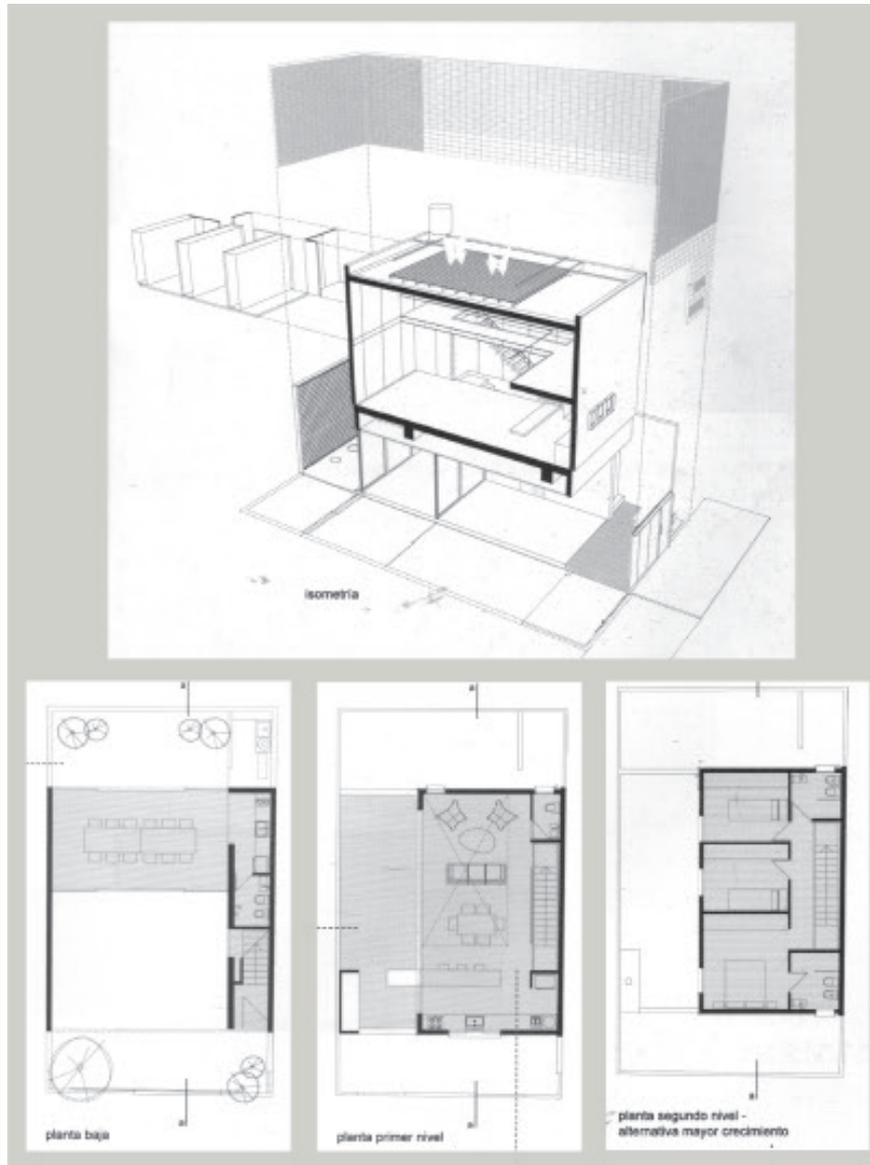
Refugio Urbano (2016): Plantas e isometría.
